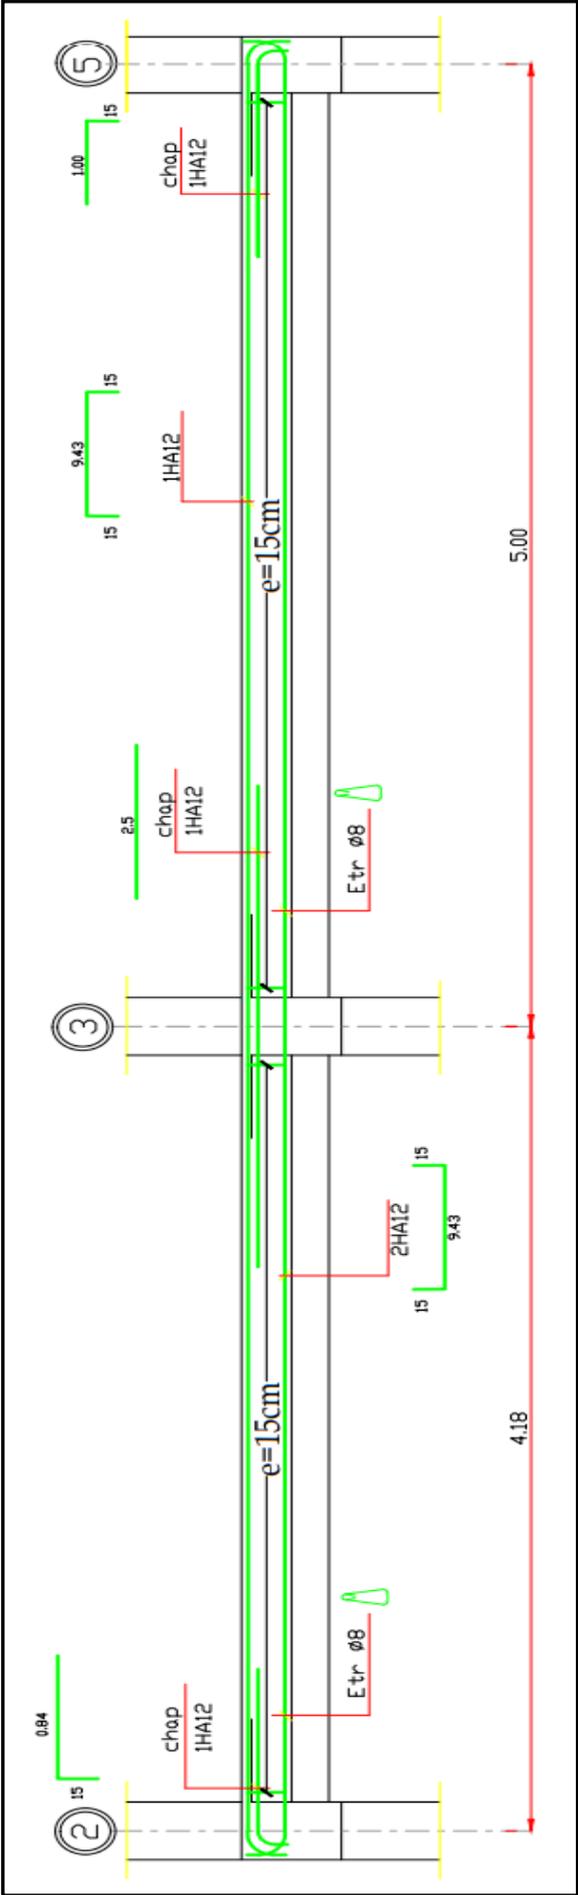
ferrailage des poutrelles intermédiaires.
